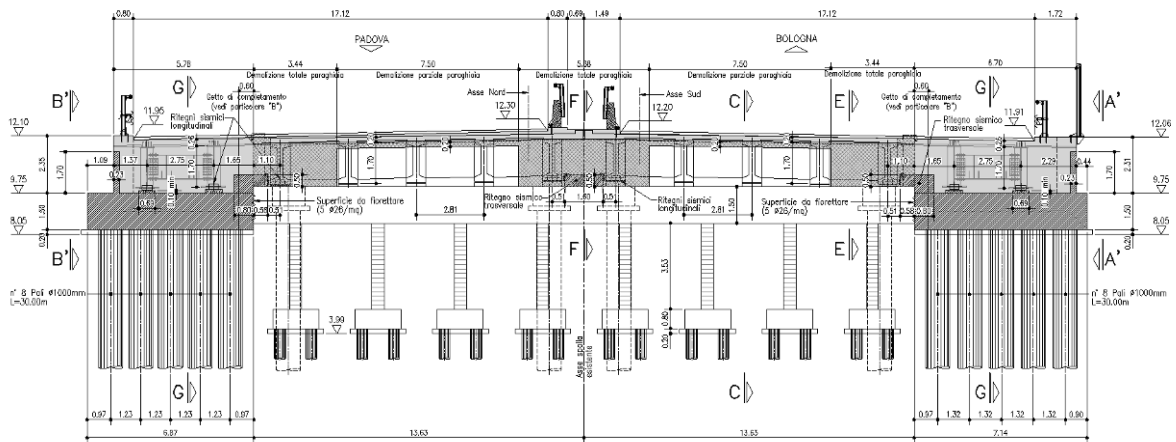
Prospetto spalla con notazione ritegni trasversali (campate laterali)
